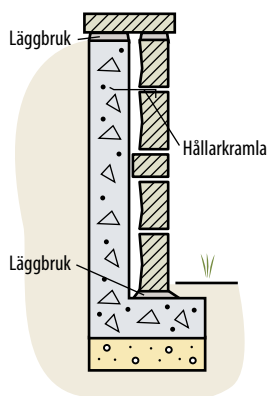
Stenblock monterade som ventilerad beklädnad mot betongstomme.
